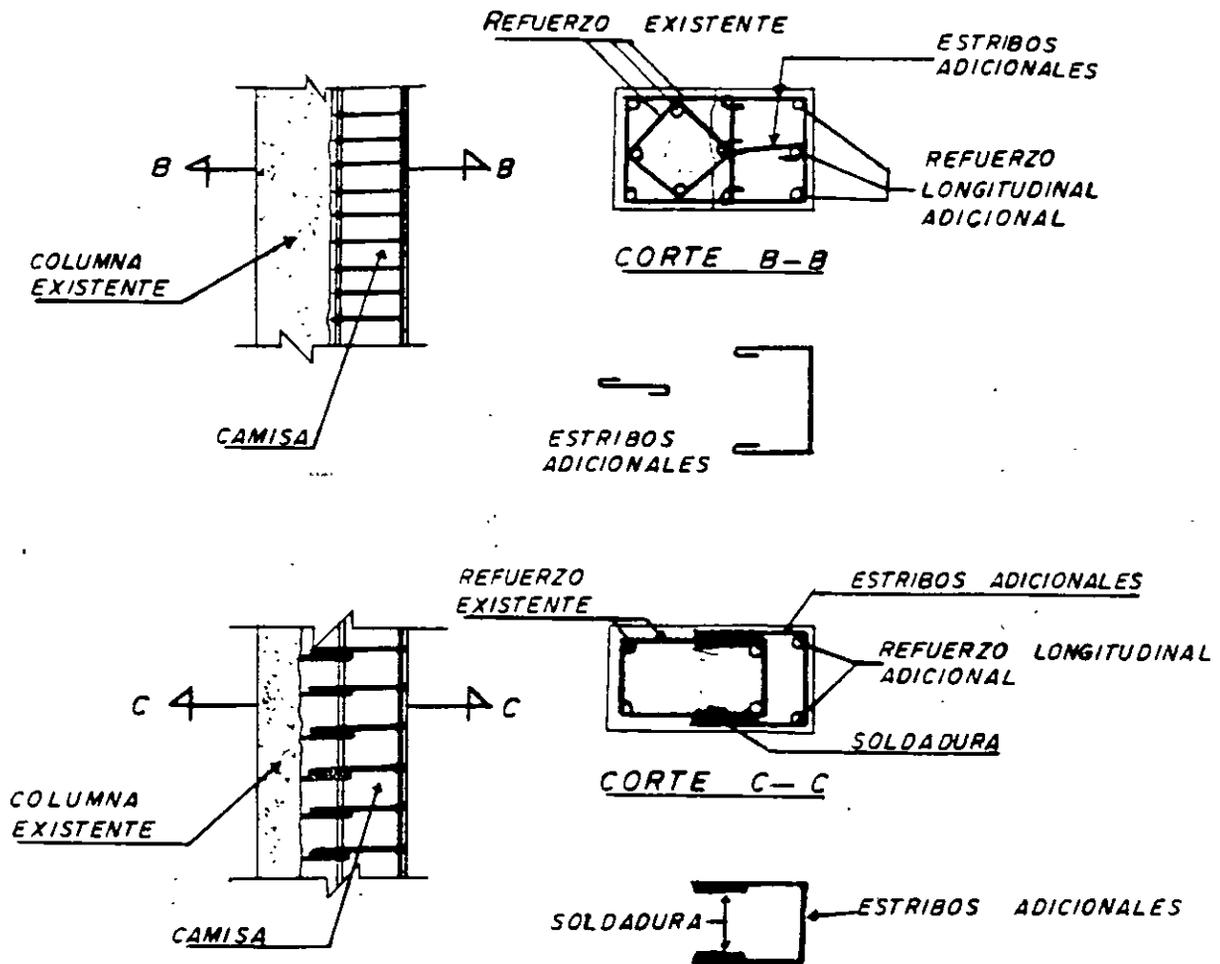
Técnicas para encamisado de columnas con concreto reforzado.
